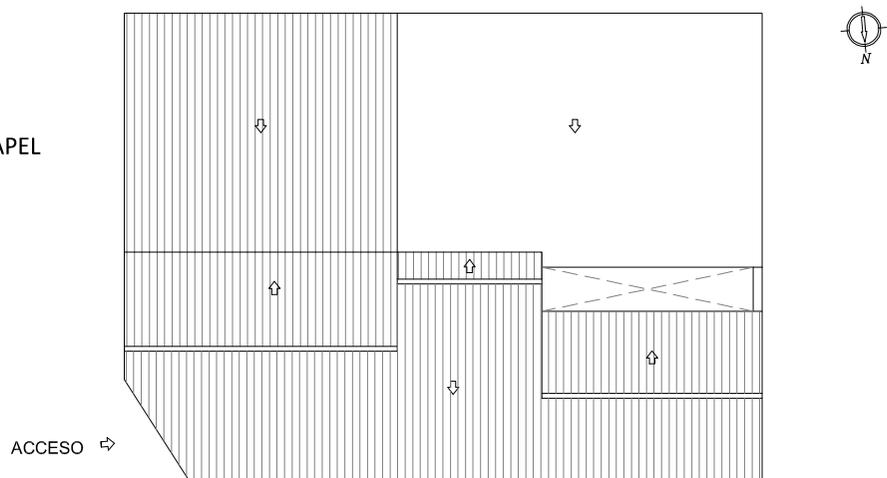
FOTO ESTADO ACTUALESQUEMA DE PLANTA
